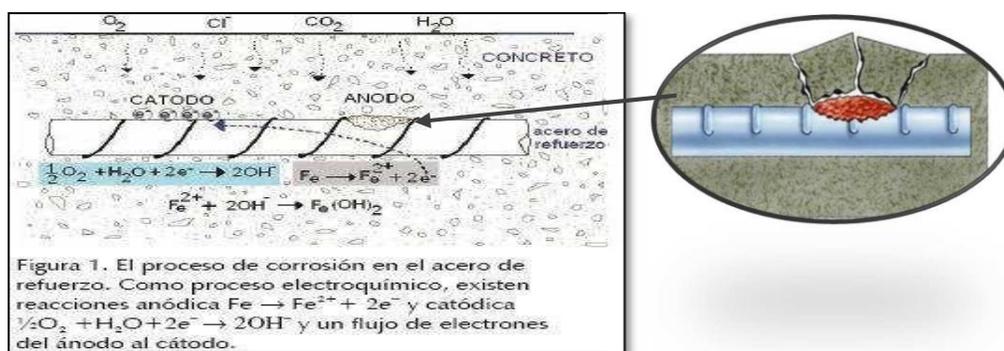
Proceso de oxidación del acero. El óxido e hidróxido férrico formado ocupa más volumen fisurando el hormigón.
